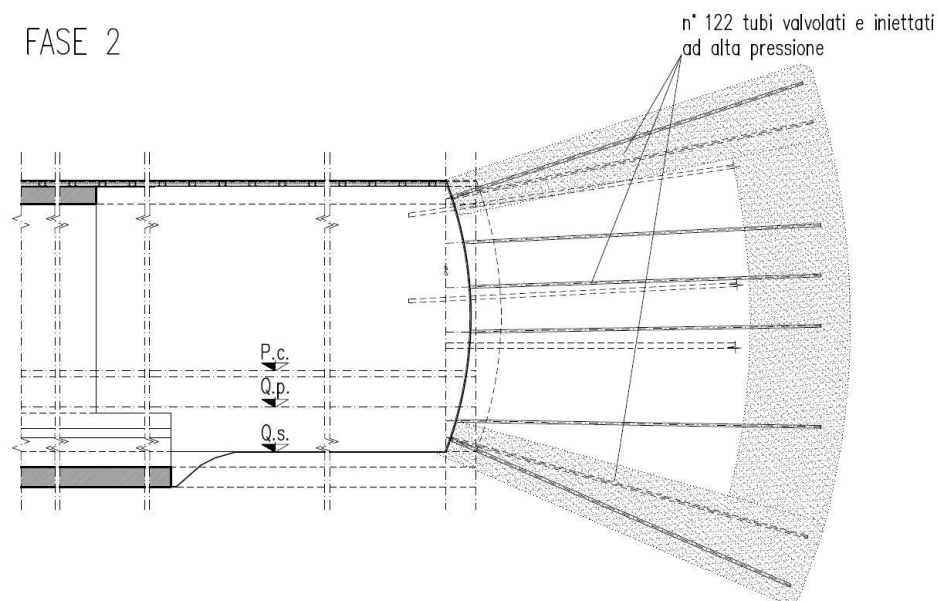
Iniezioni di impermeabilizzazione in avanzamento. Schema in sezione longitudinale
